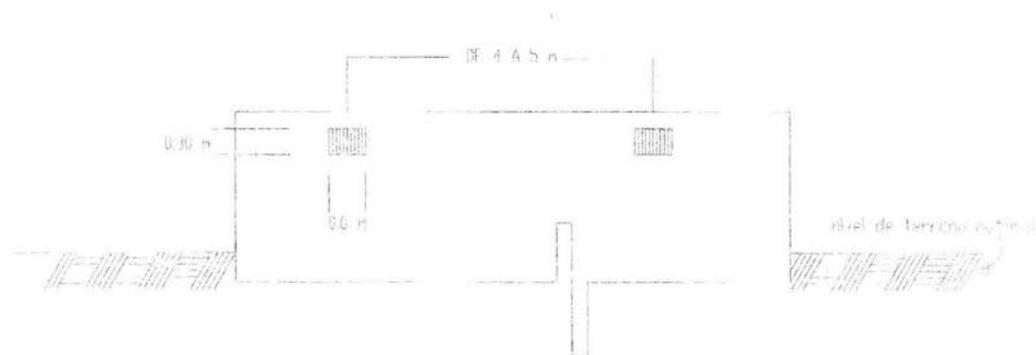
Ventilación por medio de aberturas con rejas de hierro de 30 x 60 cm, instaladas en la periferia del tanque.
